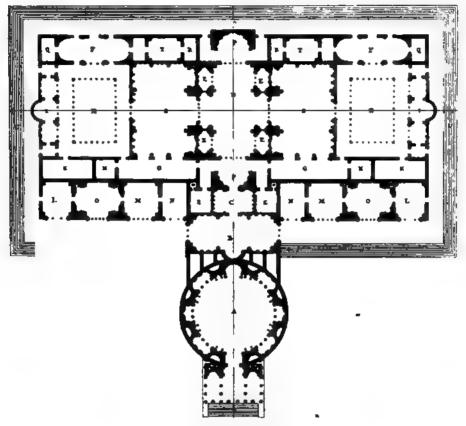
Grundrig ber Thermen des Agrippa in Rom. (Retonstruttion flehe Seite 375.)
